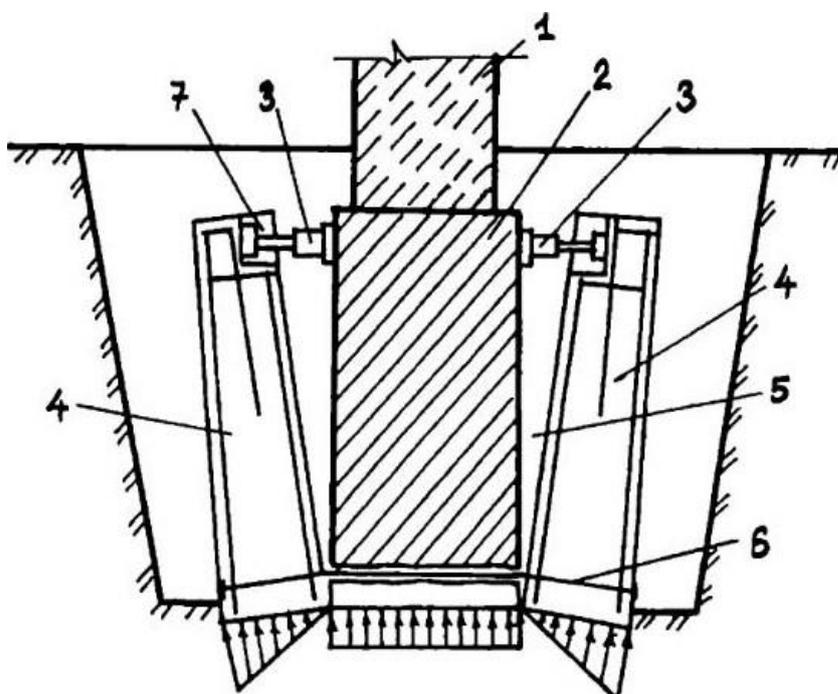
Схема усиления фундаментов дополнительными блоками,
